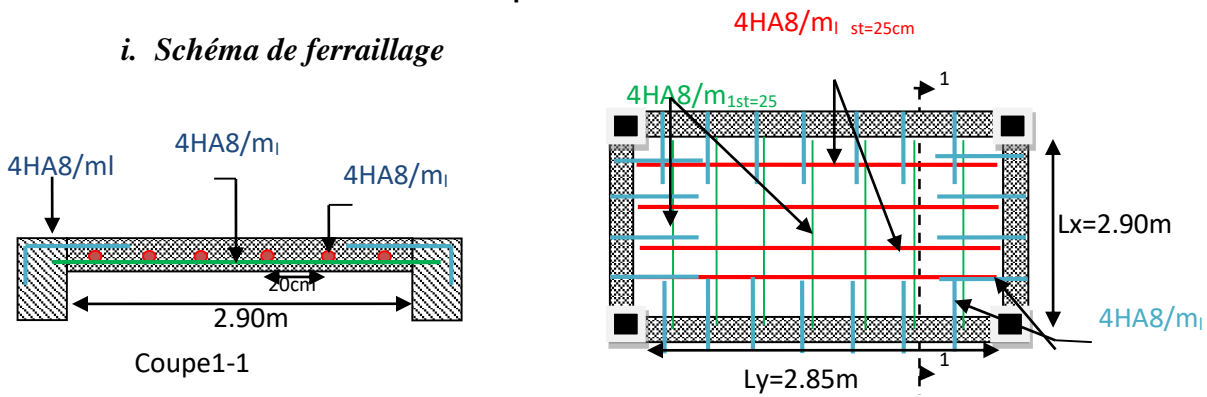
Schéma de ferrailage de la dalle poste transforme
